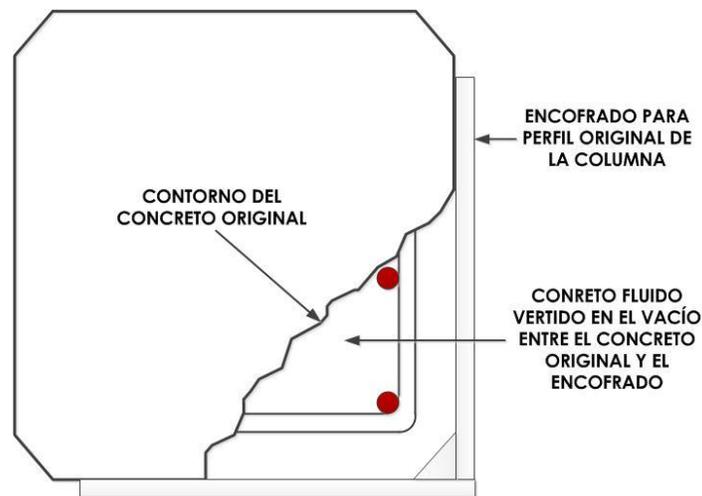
Ejemplo de aplicaciones en fluido en una columna de concreto (Ryall, 2001)
